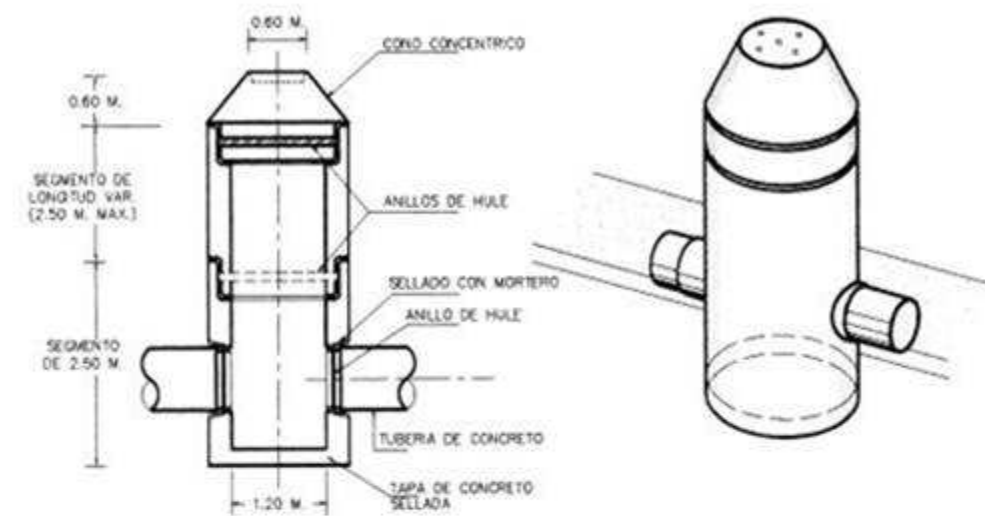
19.- POZO DE VISITA DE CONCRETO PREFABRICADO
